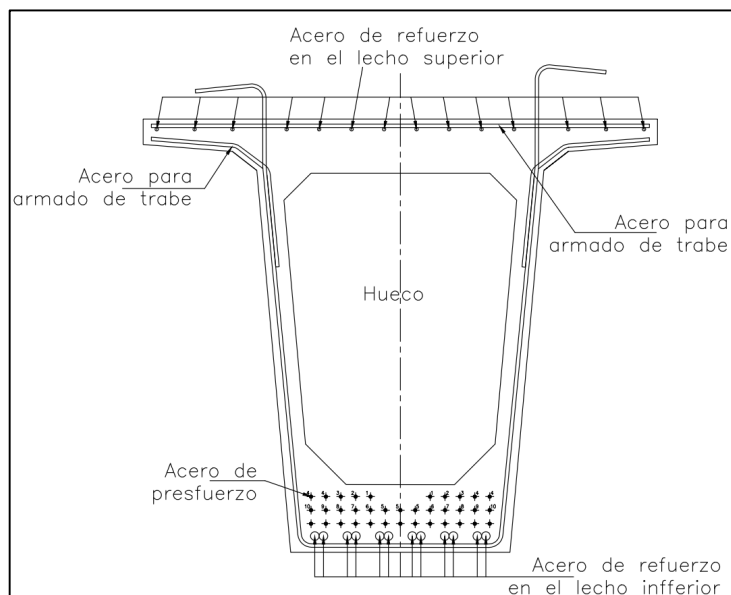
Trabajo en conjunto de acero de presfuerzo y refuerzo en trabe sección cajón
